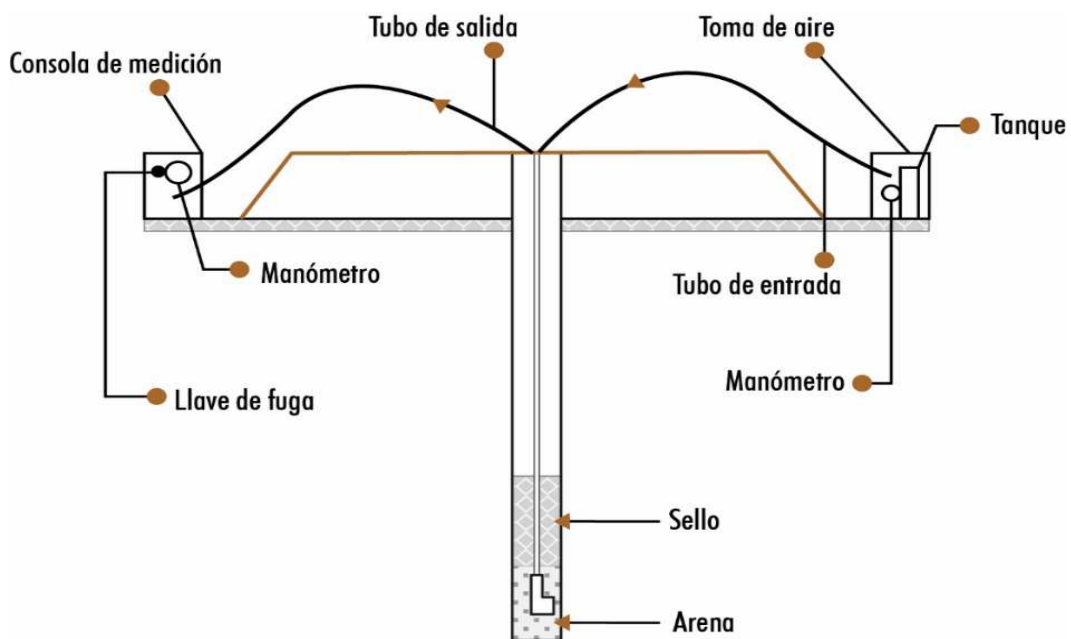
Esquema de instalación de piezómetro neumático
